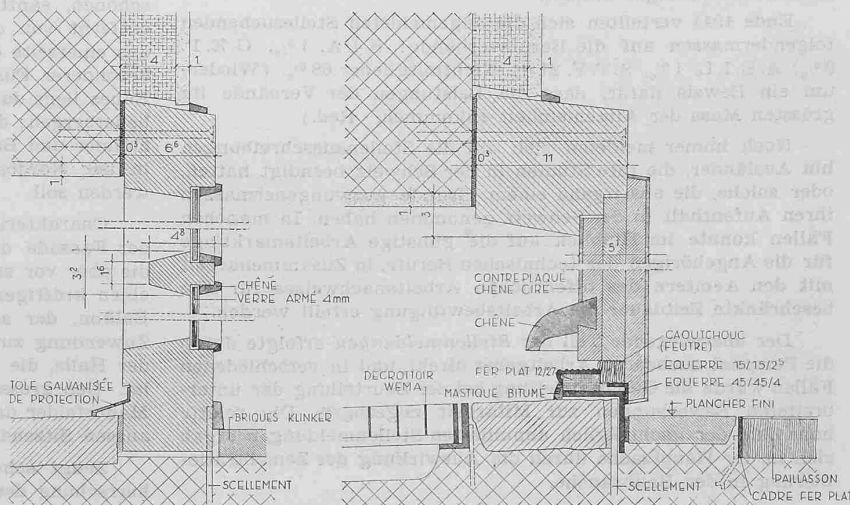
Glaswand bei der Haustüre, Grundriss-Details 1:5
